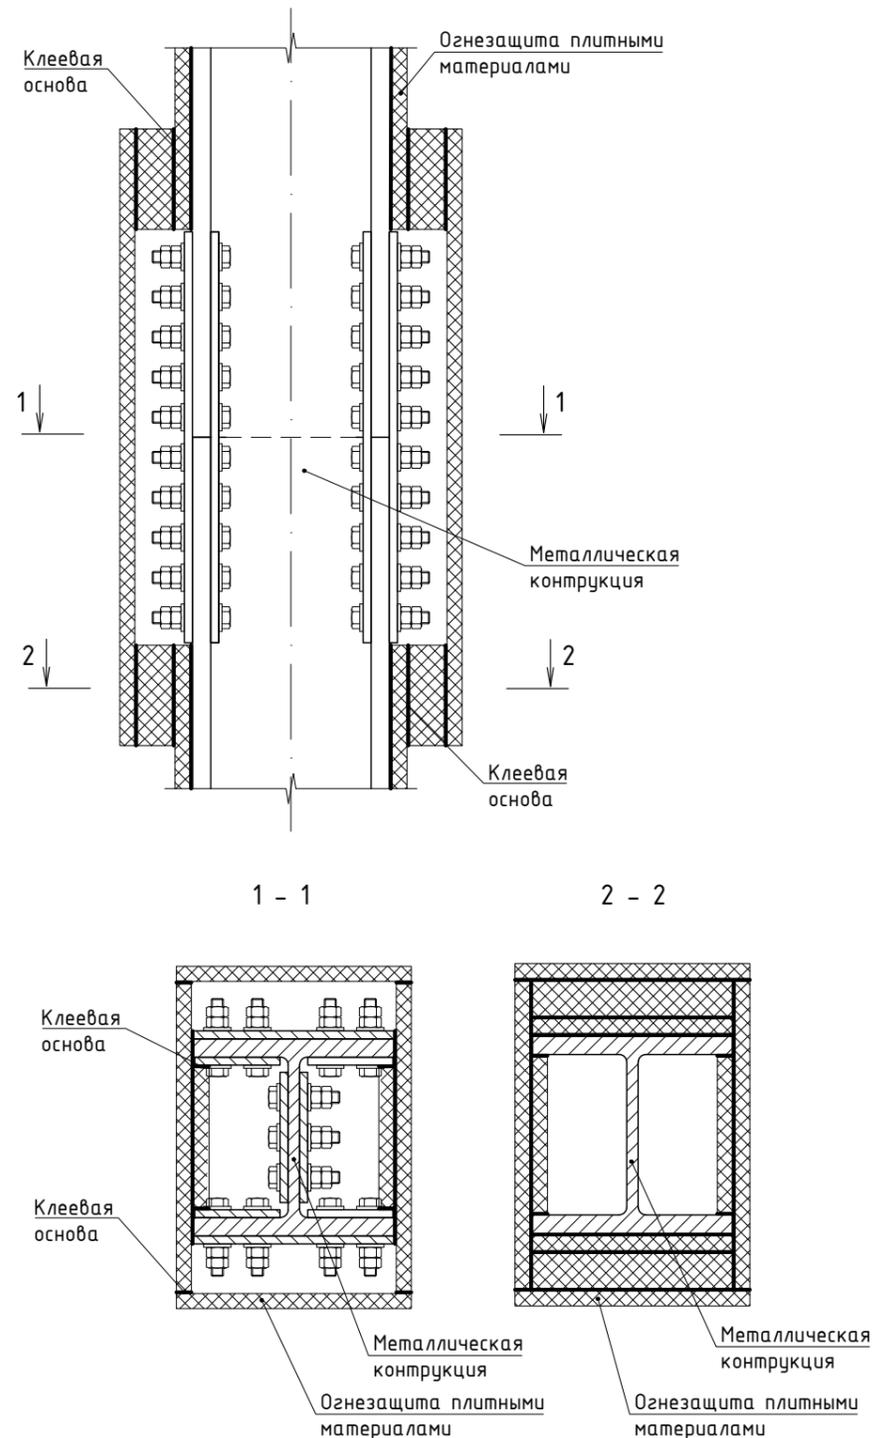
Огнезащита плитными материалами болтовых соединений металлической конструкции
